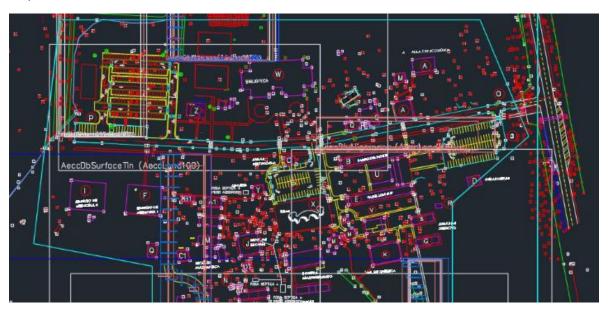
Plano Autocad de la Facultad Multidisciplinaria de Oriente.
